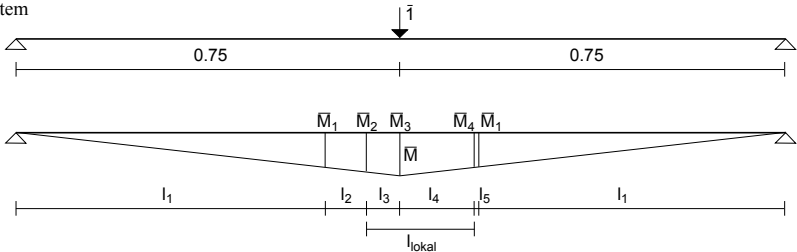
Bestimmung der Krümmung im Makroriss für Fall B (große Balken aus Normalbeton)
